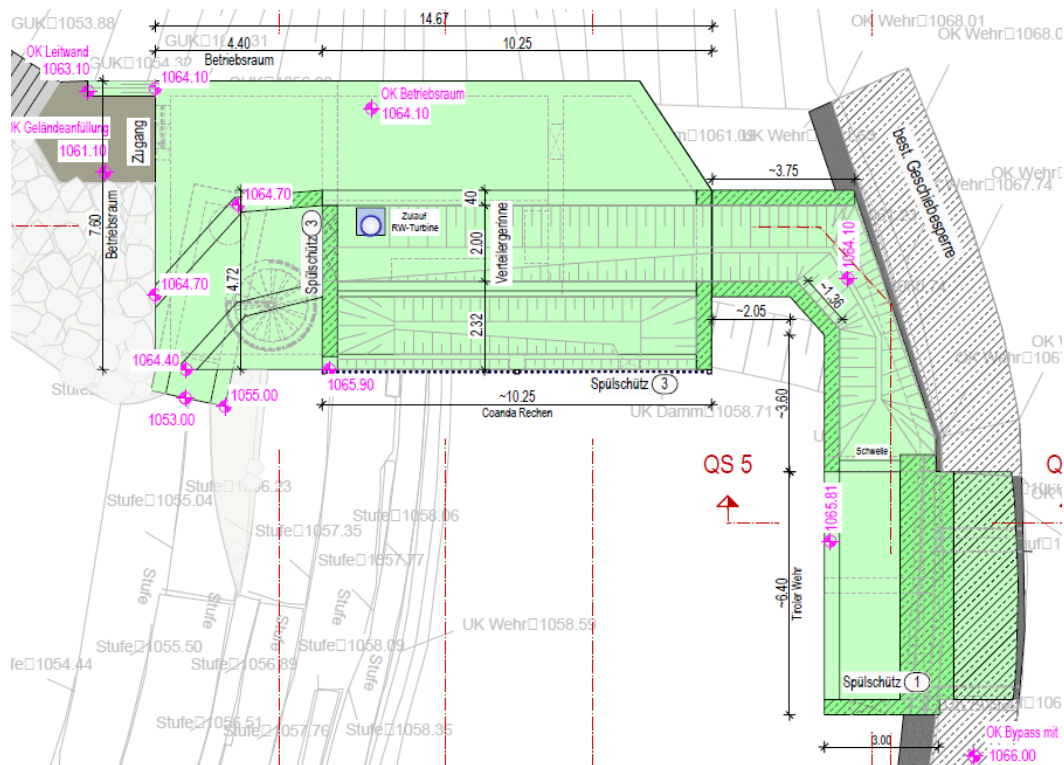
Grundriss geplanter Fassungsbauwerk – Zulaufkanal („Obergeschoss“)
